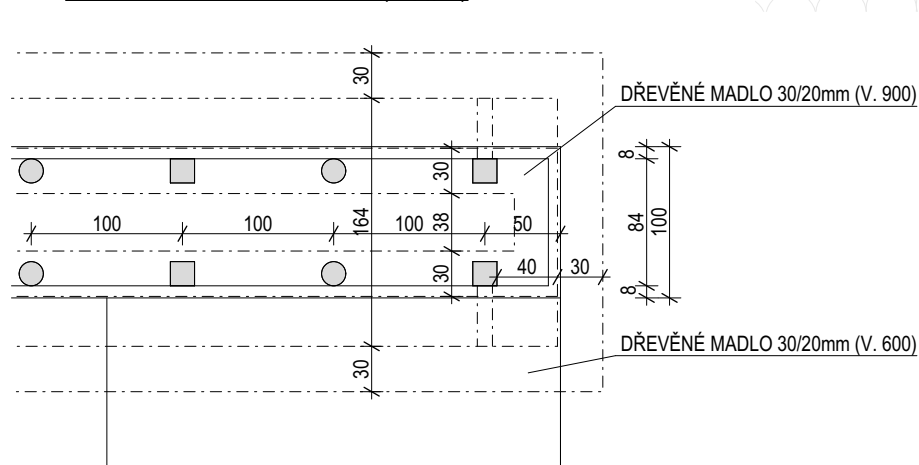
DETAIL KOTVENÍ SLOUPKŮ K OC. T PLECHU (M 1:10)
